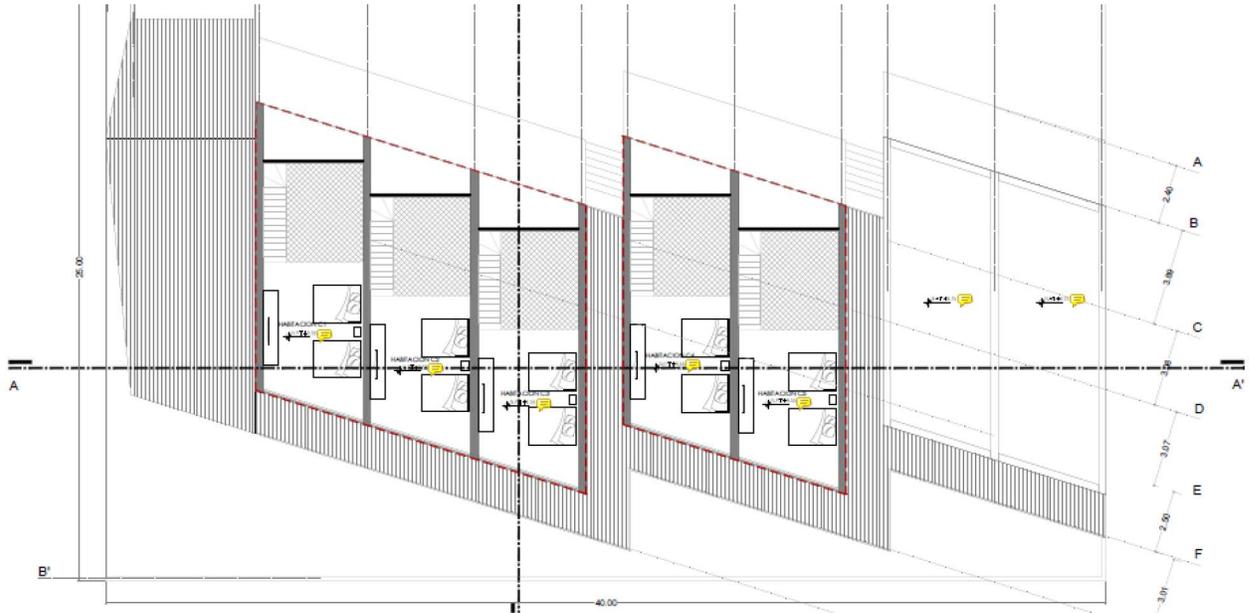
Distribución de la Planta del Nivel Tres (Mezzanine) del Proyecto.
